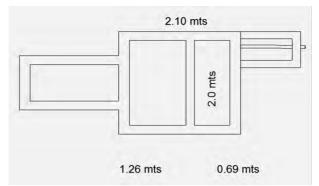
Vista planta cámara tipo 1. Fuente: Diseño cámaras de quiebre por el Ing. Javier Leytón.
